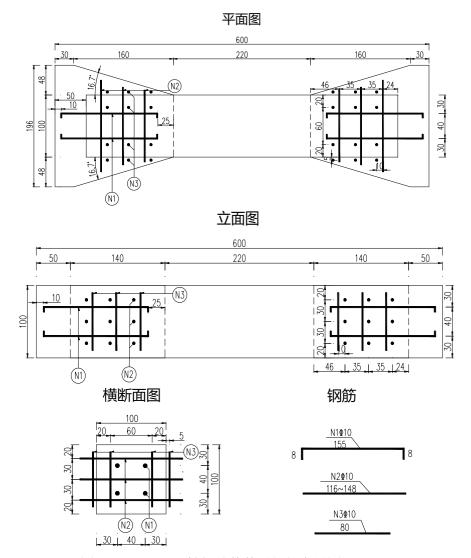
UHPC 轴拉试件普通钢筋布置图 (mm)
